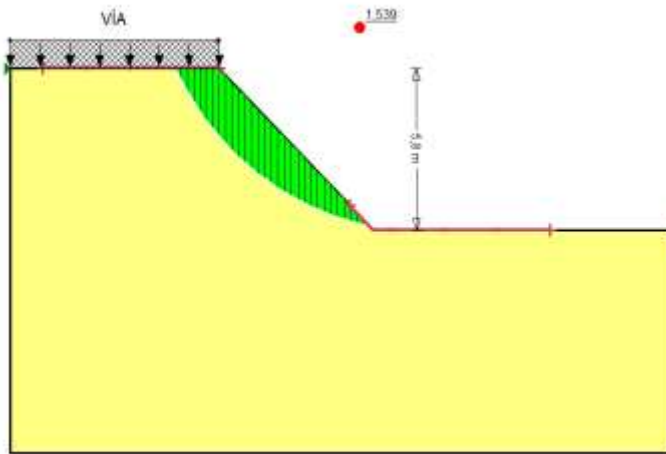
Modelo de estabilidad para excavación en talud 1H: 1V (Estático) - Puerto Madero
